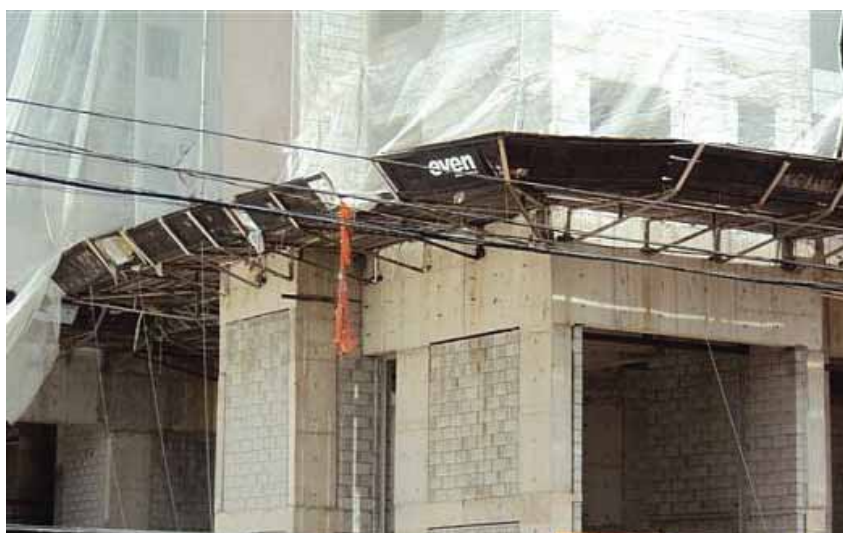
Vigas de alvenaria estrutural utilizadas para apoiar a laje da edificação
